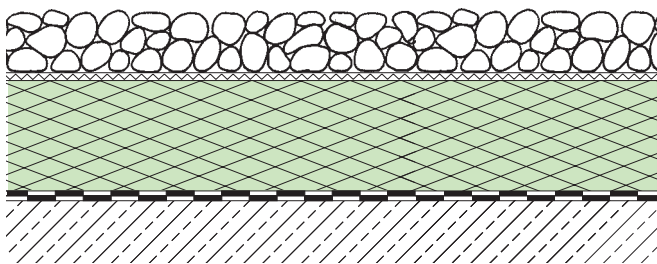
Ausführung einlagig bekiestes Umkehrdach.
